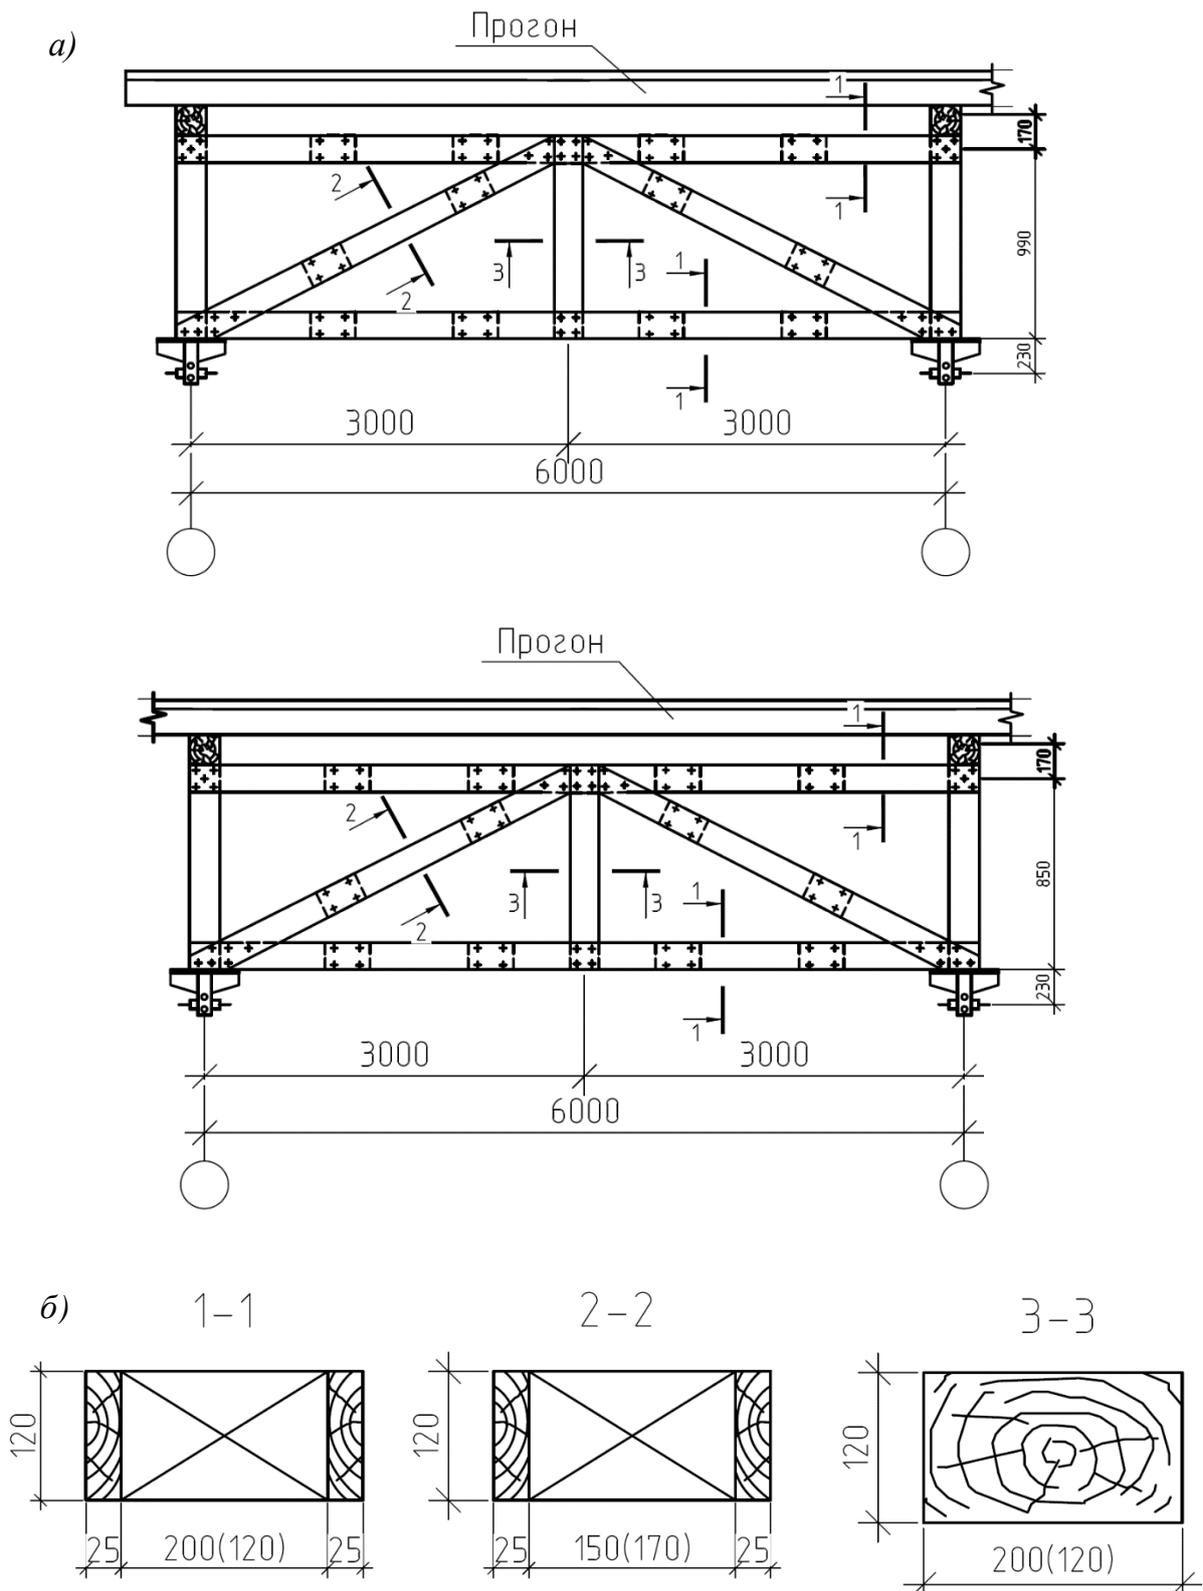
Конструкции вертикальных связей, расположенных между металлодеревянными фермами: а – связей ВС-1, расположенных между двускатными фермами; б – связей ВС-2, расположенных между односкатными фермами
